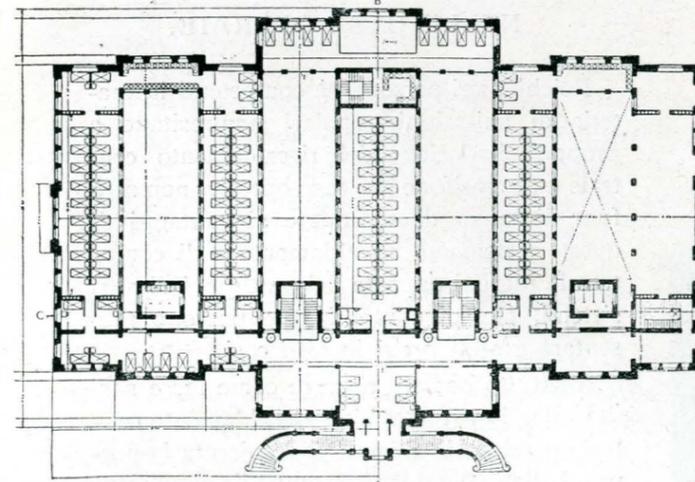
Pianta piano secondo — Caserma pompieri.
